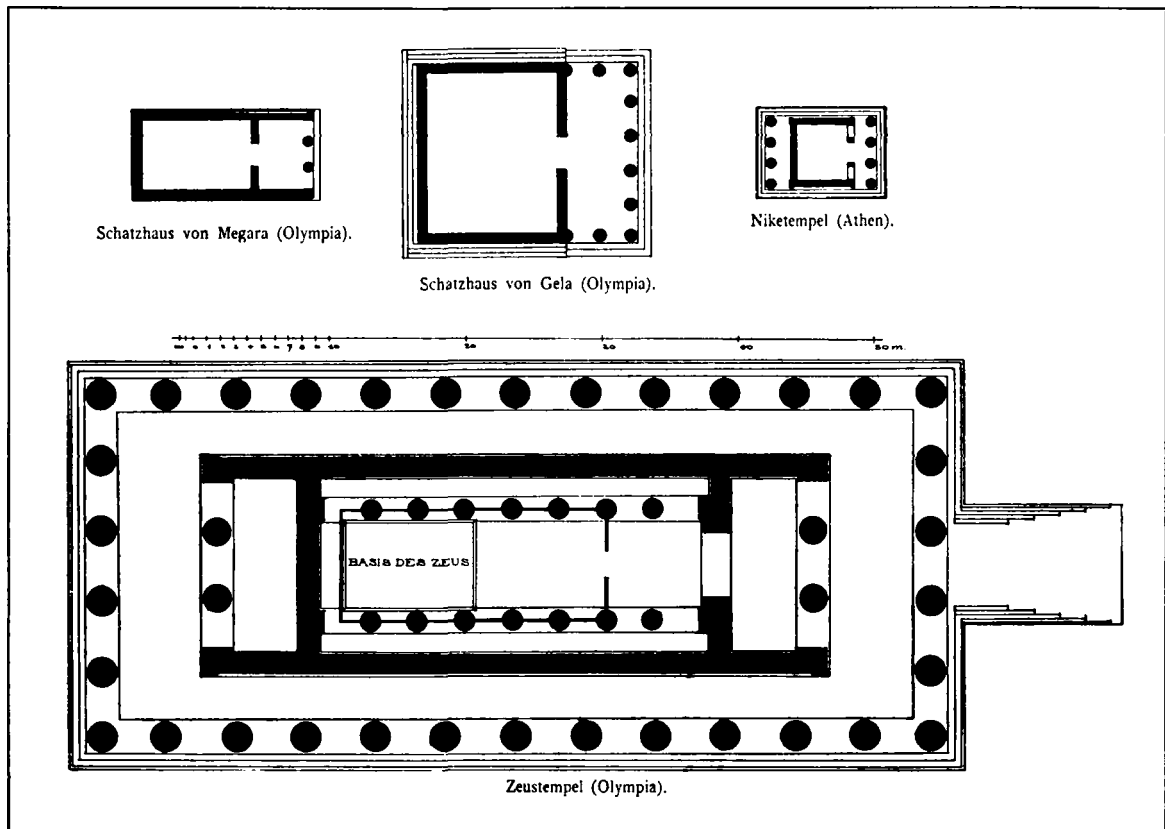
Vier Tempelgrundrisse im gleichen Maßstab.
